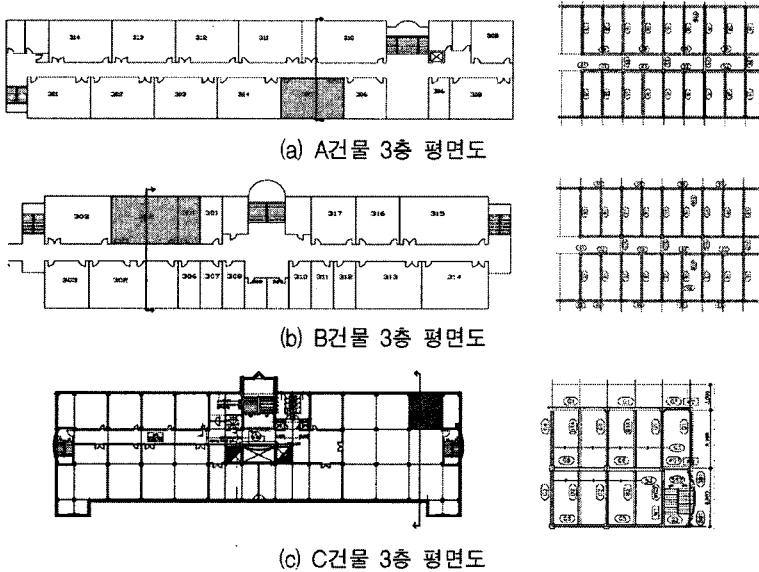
대상건물의 기준층 평면도 및 실험장소의 구조평면도
